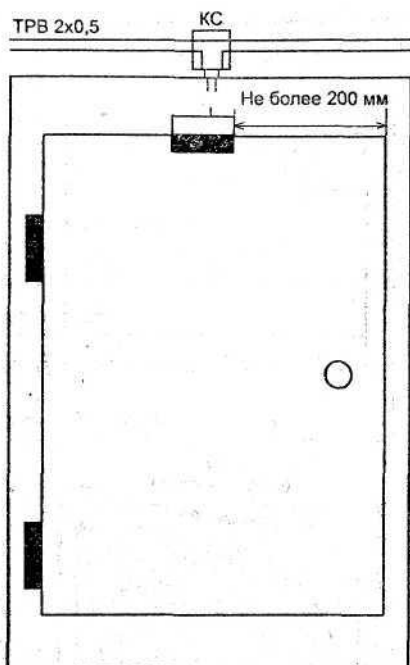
Схема блокировки дверей с помощью магнитно-контактного извещателя
